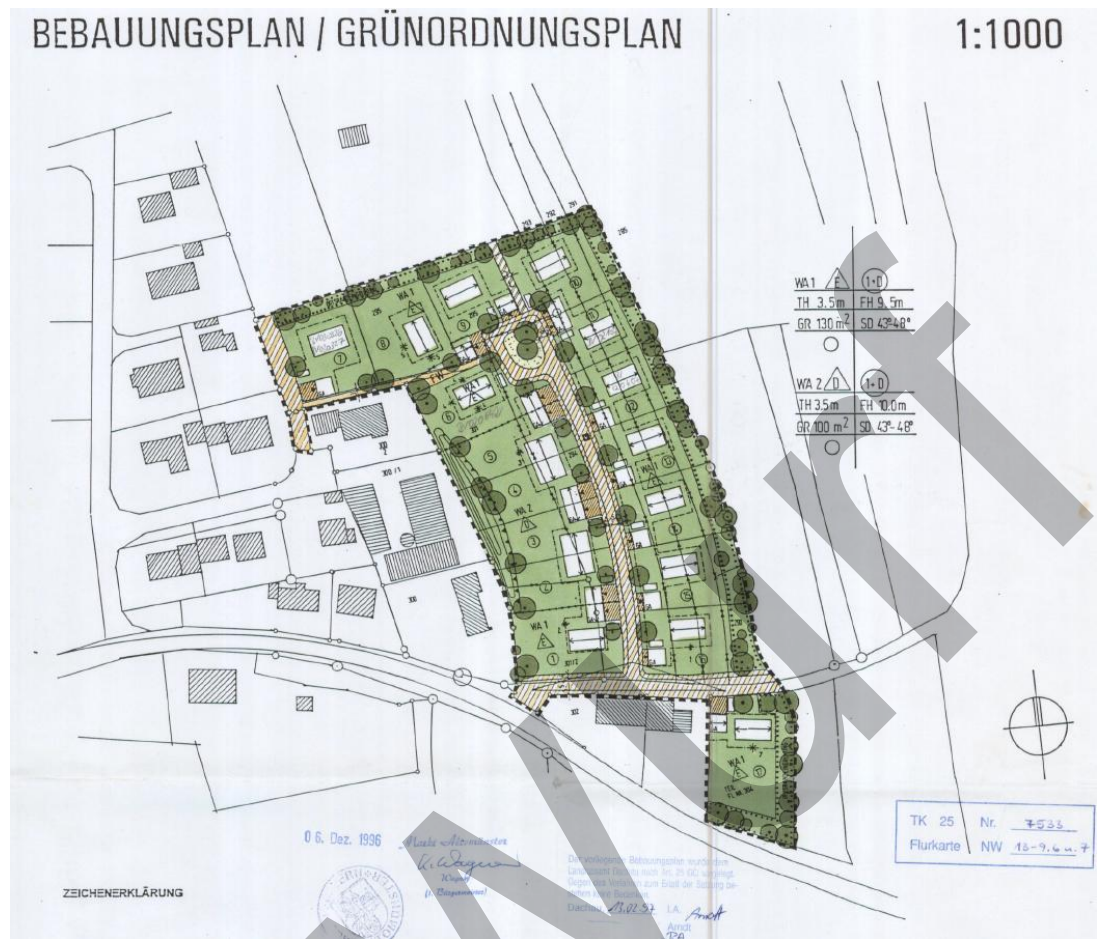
Bisher rechtsverbindlicher Bebauungsplan Pipinsried Nr. 3 „Pipinsried Hofstatt“, Planzeichnung, ohne Maßstab
